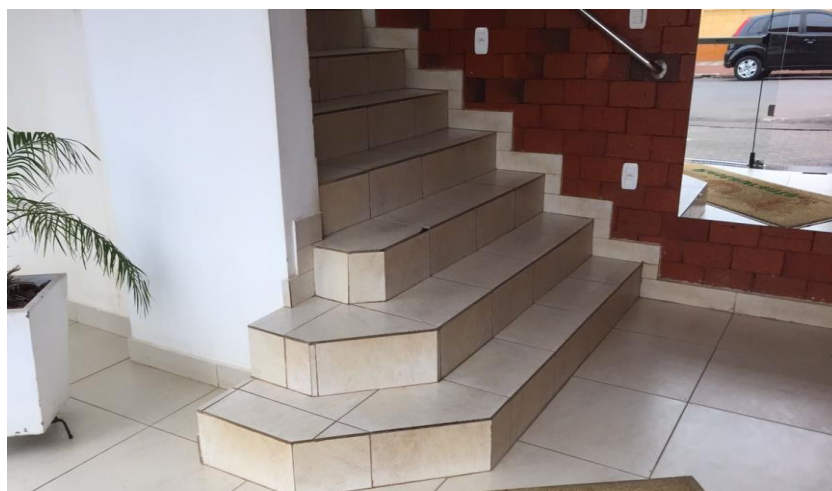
Foto do restaurante (proprietário participante B) – escadas para o restaurante que fica no 2º andar – vista lateral
